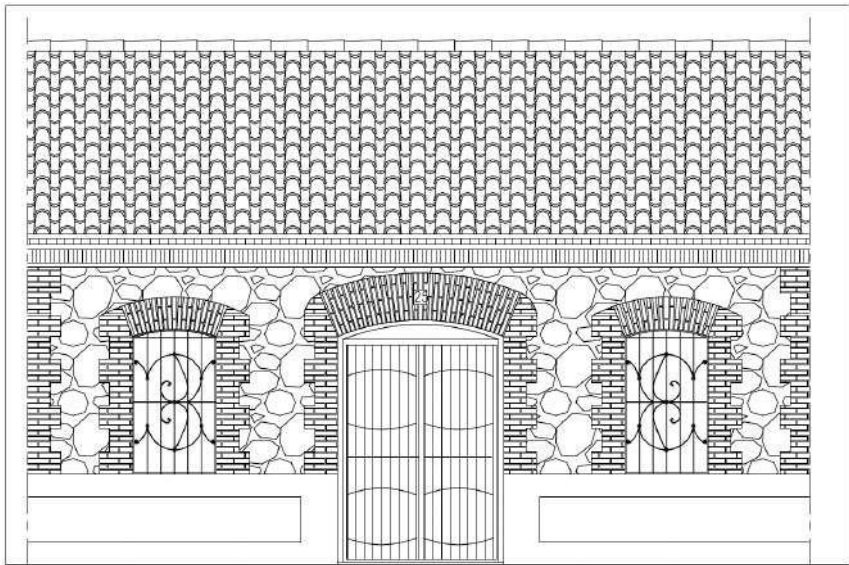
Fachada y huecos existentes en vivienda. Fuente propia
